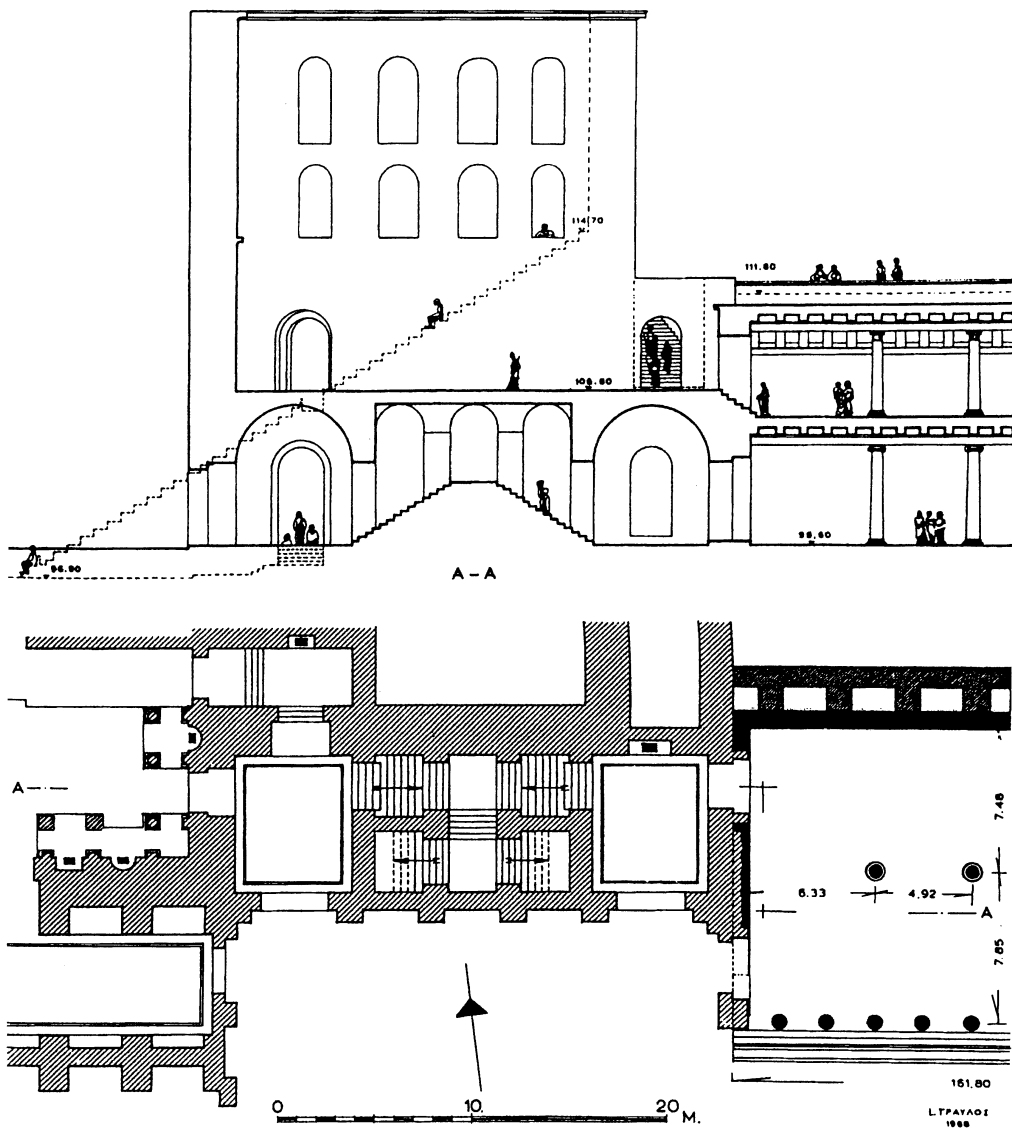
Odeion des Herodes Attikus. Treppenhäuser. Grundriss und Querschnitt (Galli 2002, Abb. 11,1, 11,2-3)
